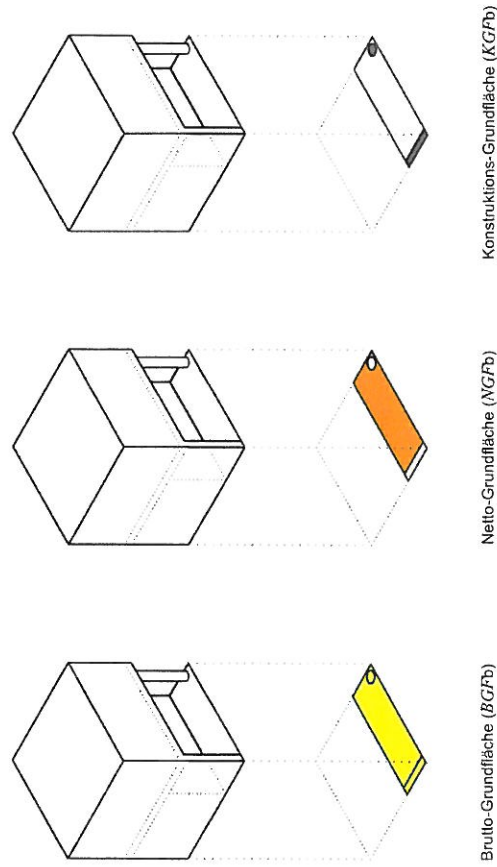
Geschossbezogene Grundflächen im Bereich b
